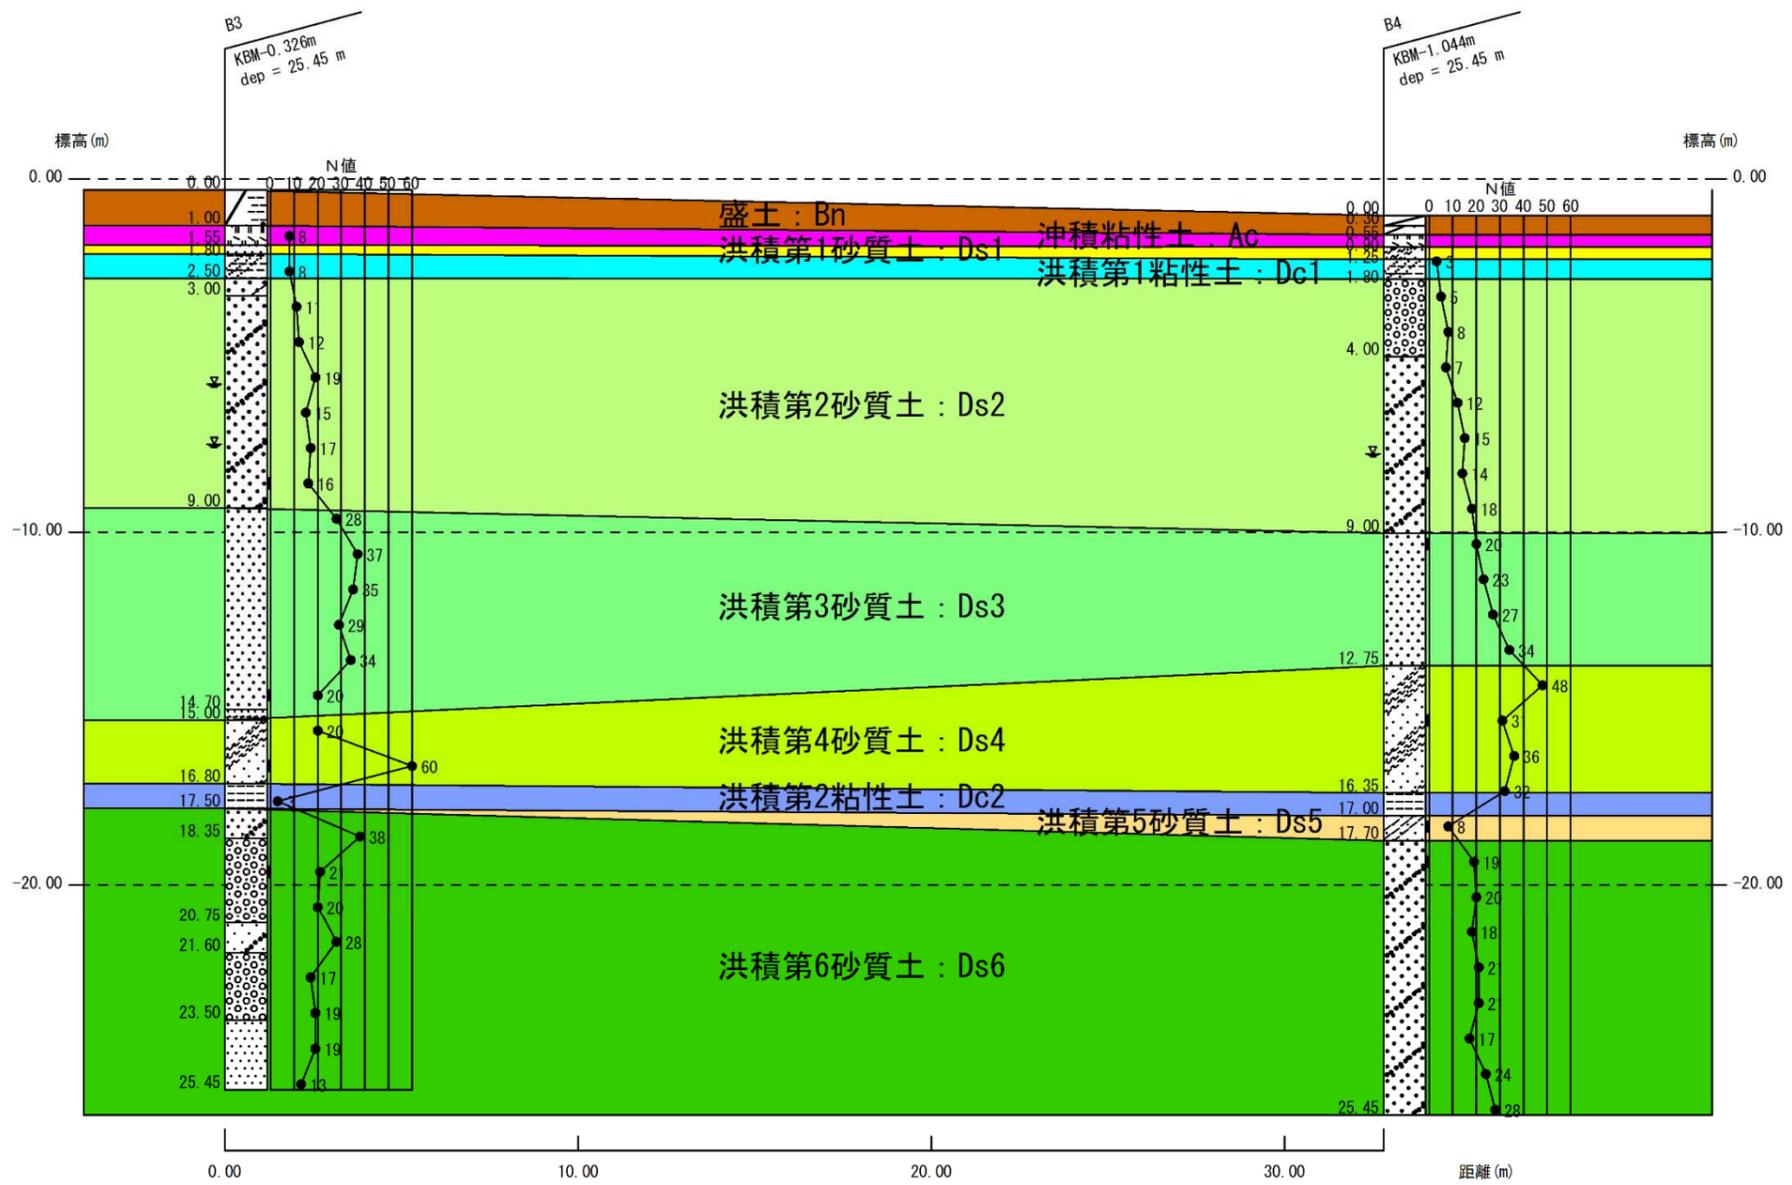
推定地層断面図 B3-B4 (S=1/200)
